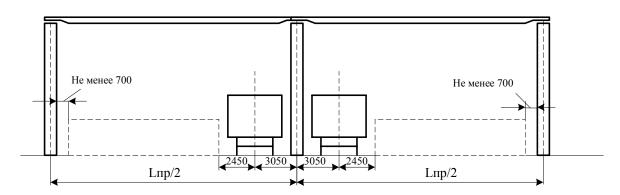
Поперечный разрез двухпролетного склада с мостовыми кранами (автопроезды поперечные)
